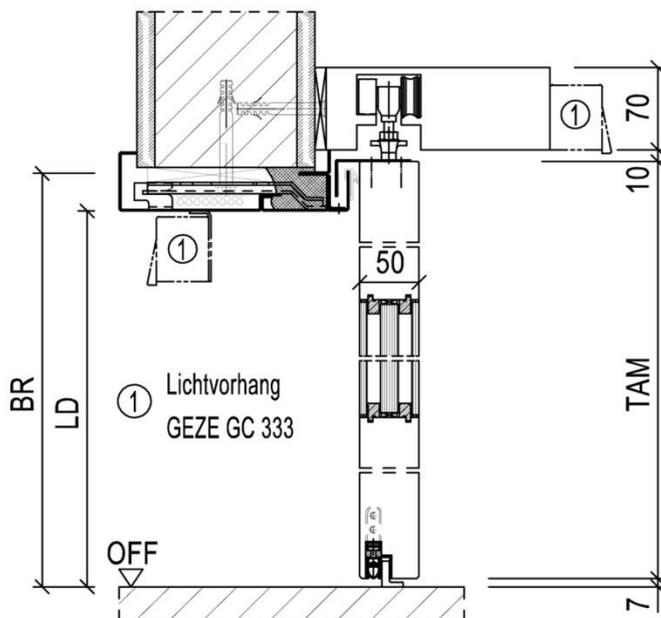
Zeichnung der einflügeligen Brandschutz-Schiebetür Typ 3N-ST in Mauerwerk. Zweiteilige Schiebetürstahlzarge, Automatik-Ausführung, auch mechanisch erhältlich.
